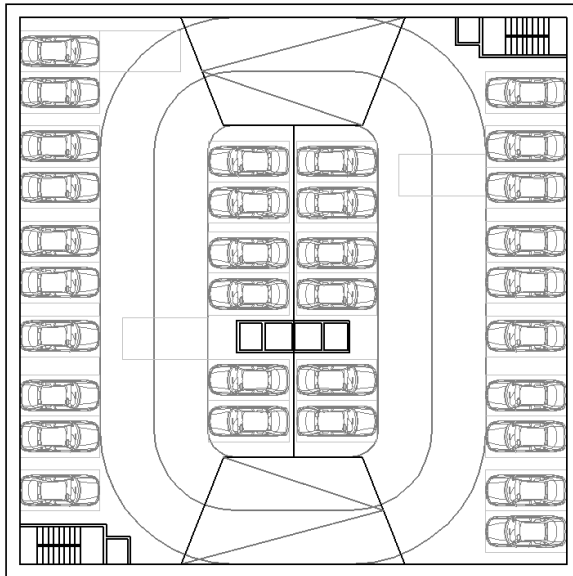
Planta de garaje tipo. Fuente: elaboración propia
